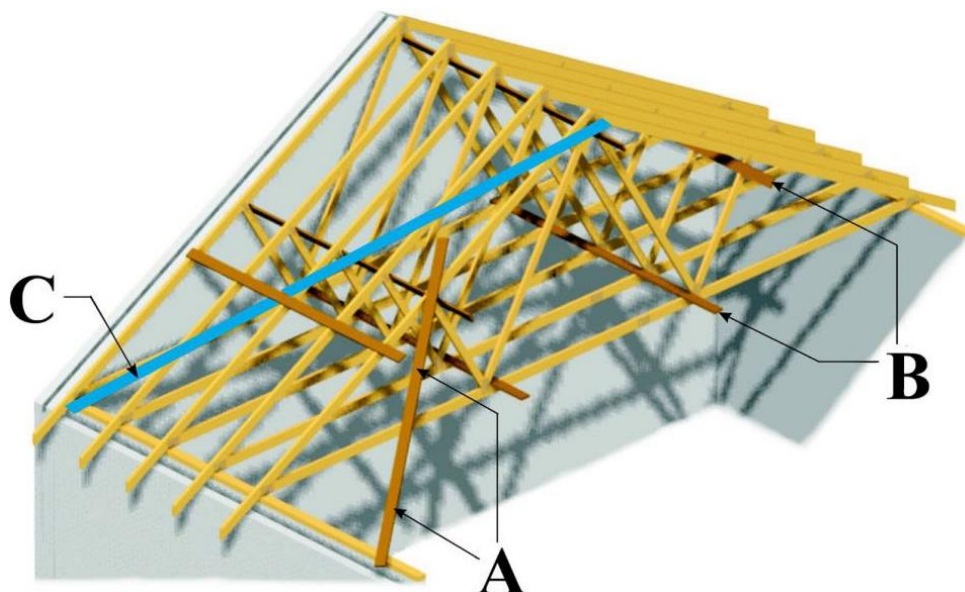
Przykładowe rozwiązanie konstrukcji dachowej oraz sposób zacięcia elementów drewnianych.
